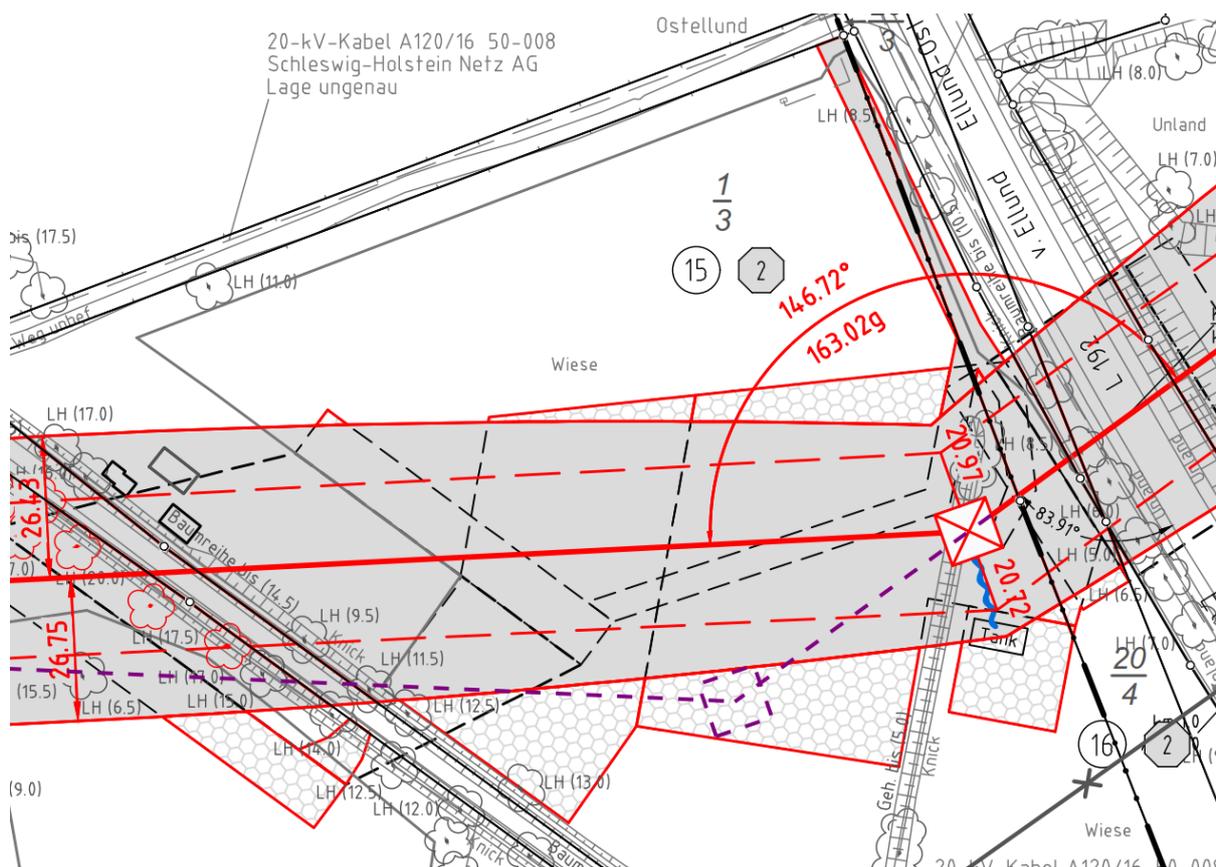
Ausschnitt aus dem Lage-/Bauwerksplan zu Mast 23
